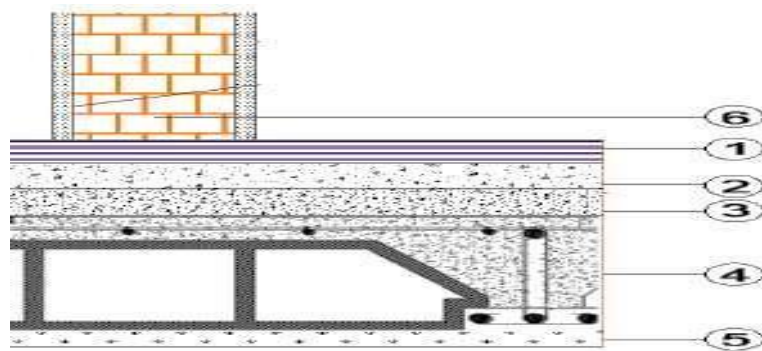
Coupe verticale d'un plancher d'étage courant
